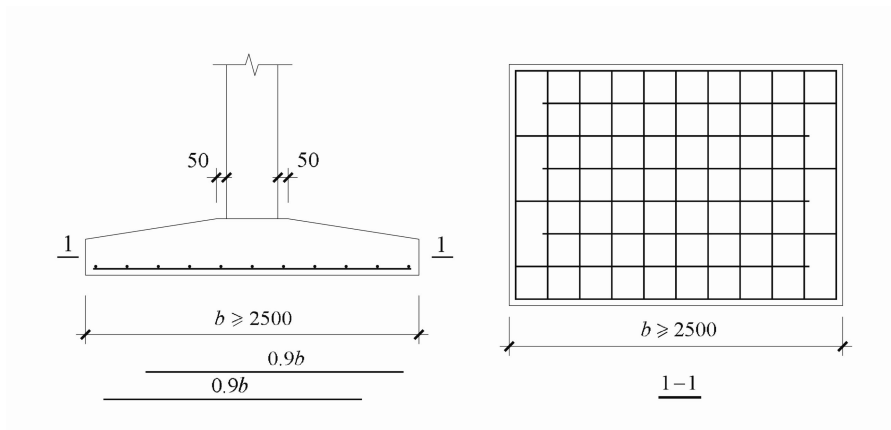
柱下独立基础底板受力钢筋布置
